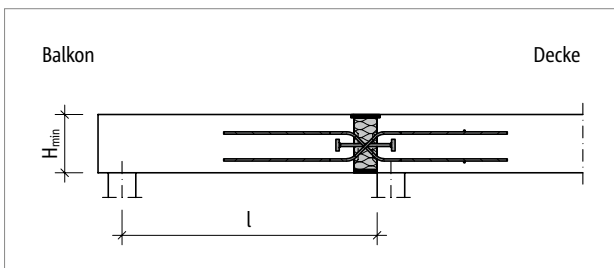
Schöck Isokorb® T Typ QP-VV: Statisches System
